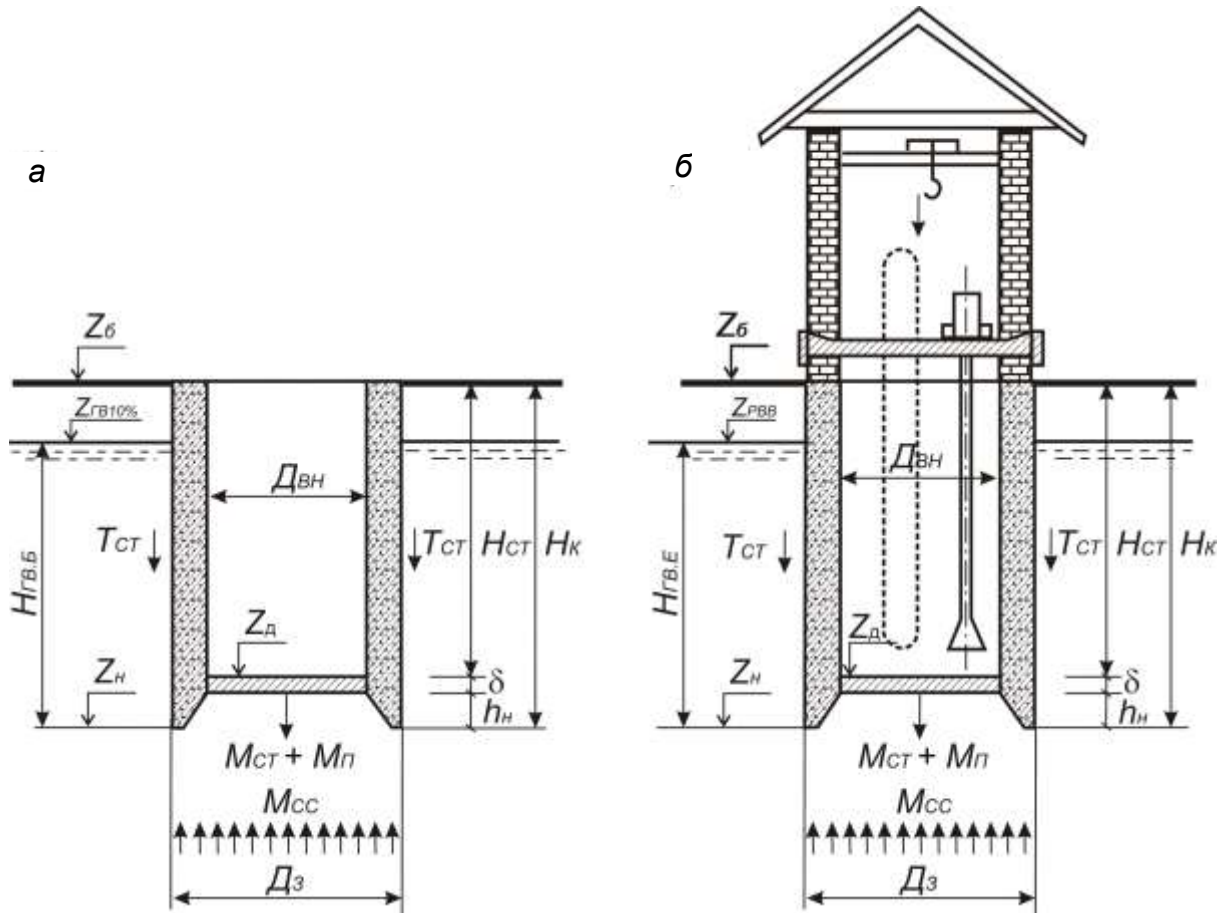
Розрахункові схеми на спливання берегового водоприймально-сіткового колодязя: а – будівельний період; б – експлуатаційний період
